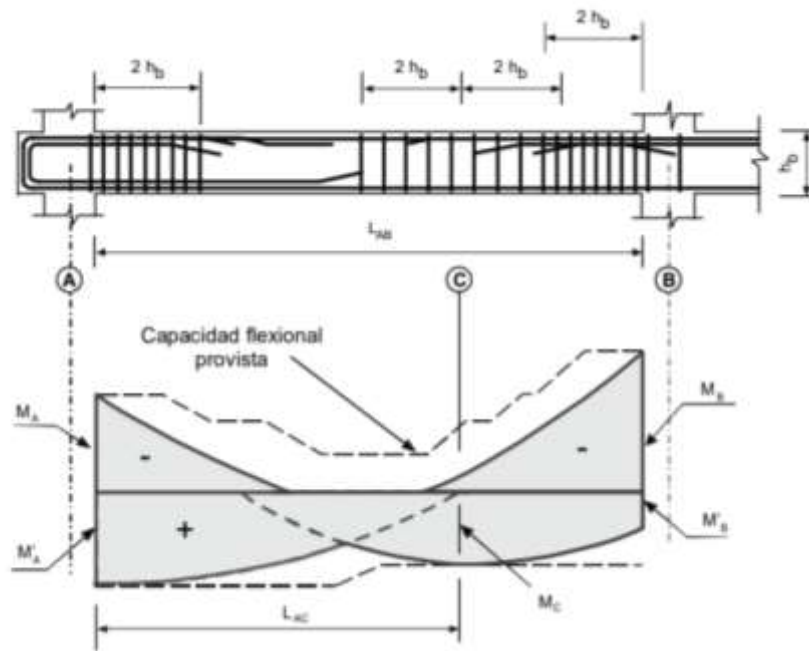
Longitud de las zonas de formación potencial de rótulas plásticas cuando la sección crítica se ubica en la cara de la columna y en el tramo de la viga.
